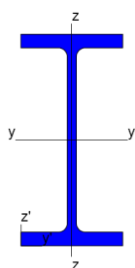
Pilar planta 7a, 8a, 9a, 10a i 11a. [1]
